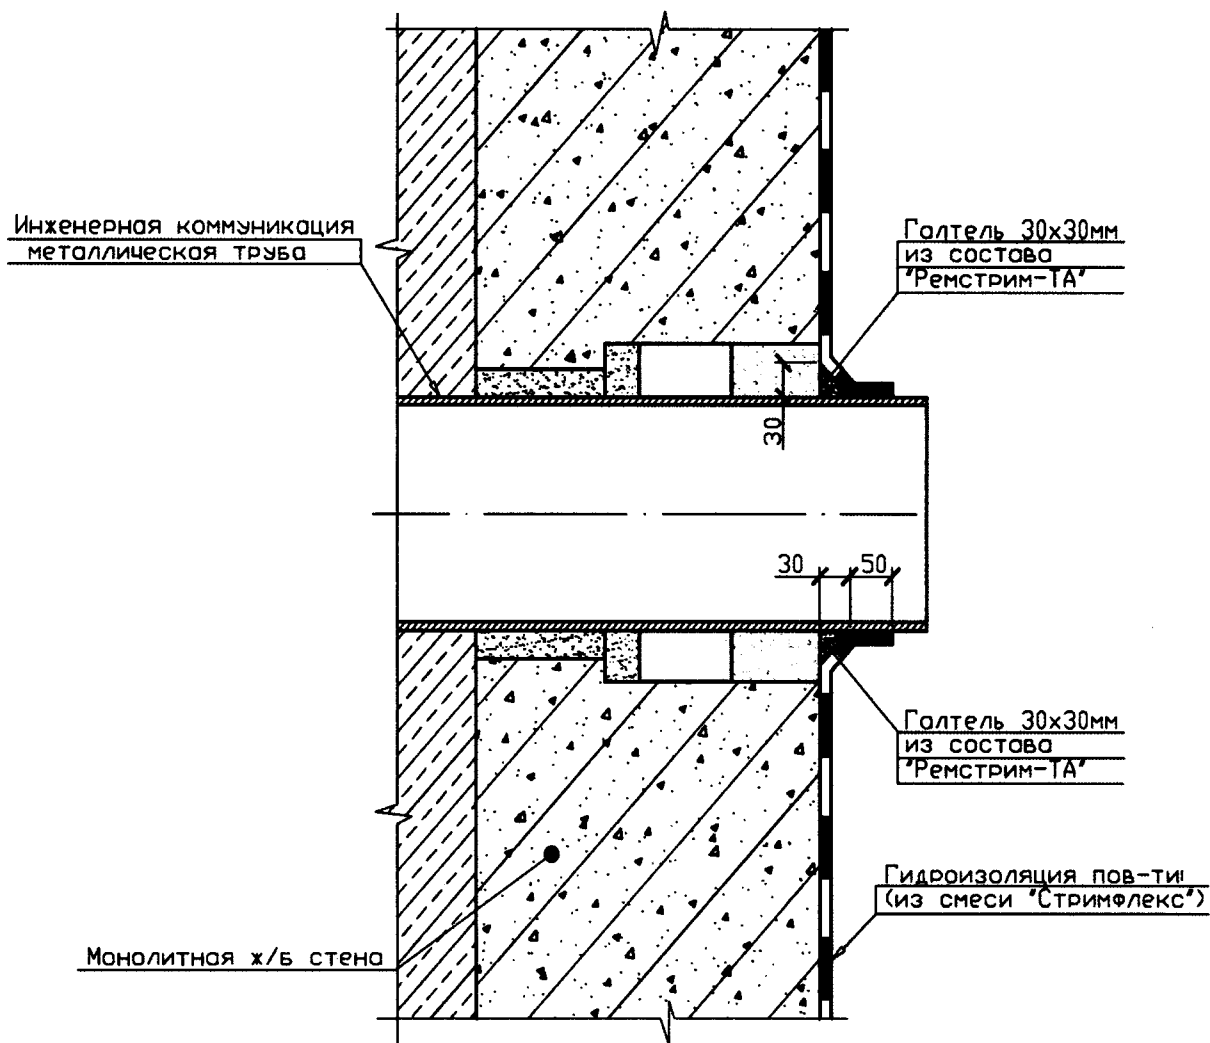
Гидроизоляция поверхностей монолитных железобетонных конструкций. Гидроизоляция поверхностей наружных стен в зоне места ввода инженерной коммуникации
